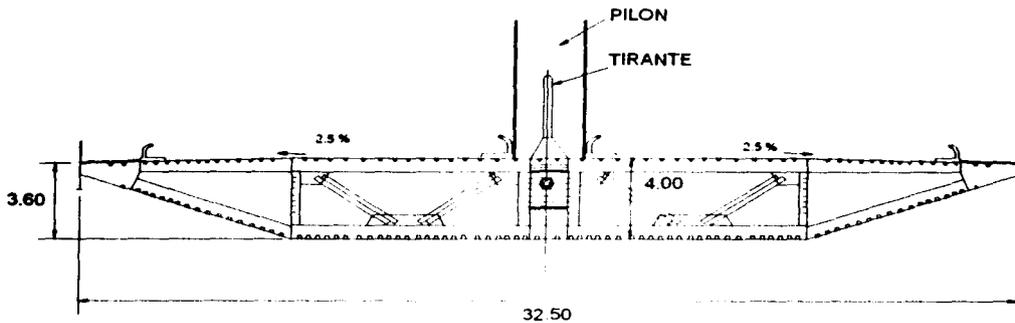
12 Sección transversal del puente Chao Phrya en Bangkok
